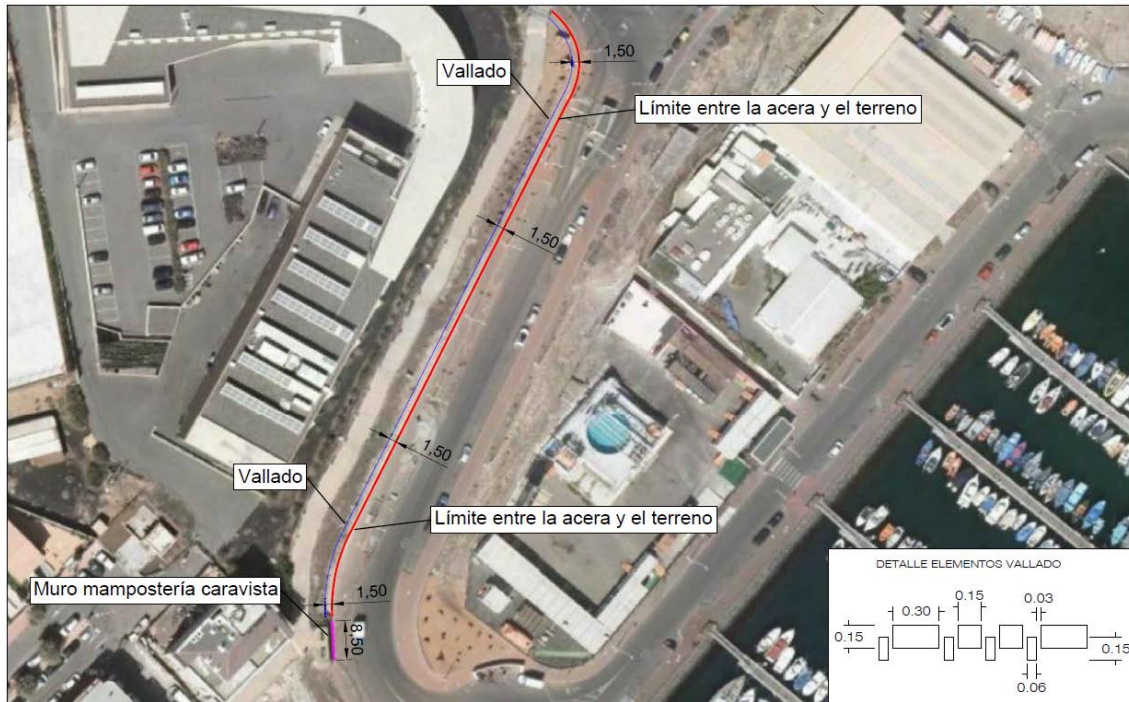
Planta tramo 2 (caseta principal-cofradía)
